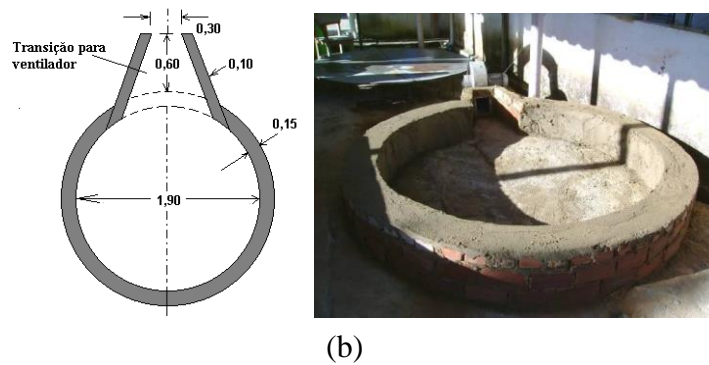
Bases dos silos: (a) planta baixa e (b) base em construção.
